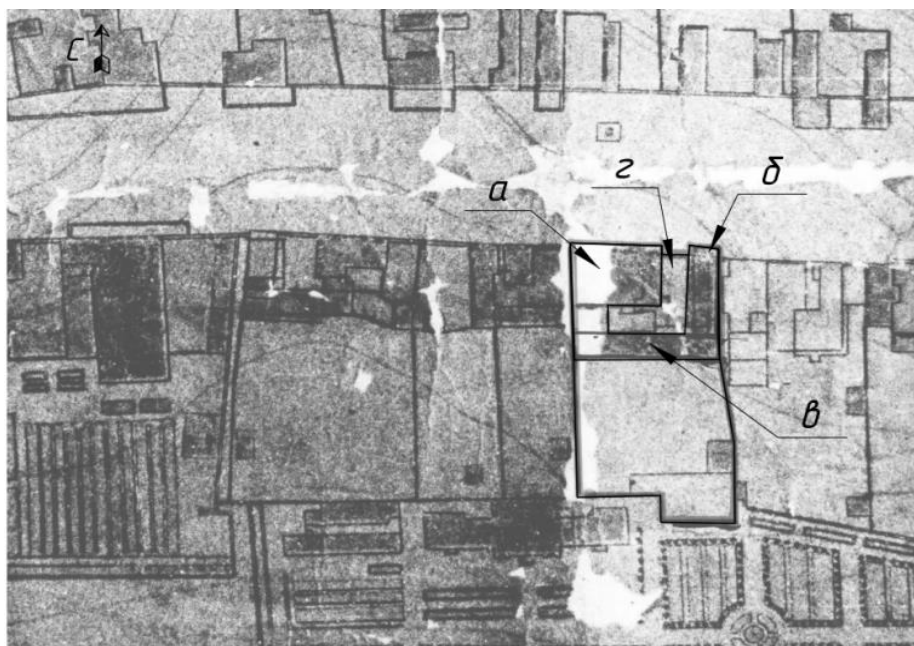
План Алори и Бержье 1870-1880 гг. из архива главного архитектора Нижнего Тагила: а – главное здание (бывший жилой дом); б – флигель; в – каменные службы; г – внутренний дворик
